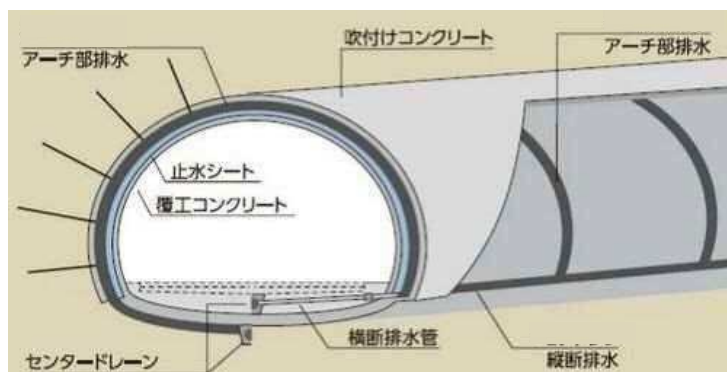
裏面排水材の施工概要図 ³⁶⁾
